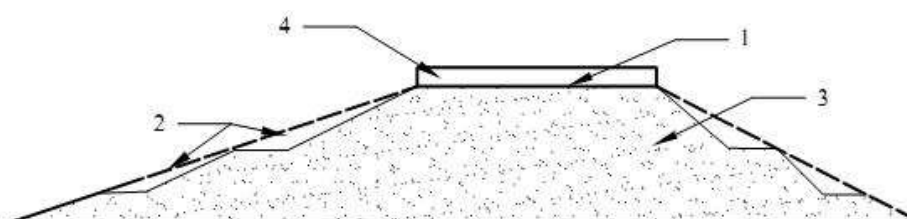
Устройство уступов с перемещением грунта на гребень плотины, после предварительного удаления разуплотнённого грунта с откосов и гребня плотины, и послойным его разравниванием: 1 - гребень; 2 - уступы; 3 - плотина; 4 - перемещённый грунт
